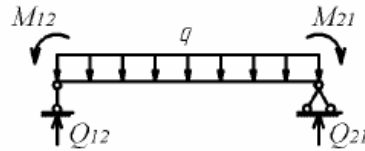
Расчетная схема ригеля крайнего пролета
